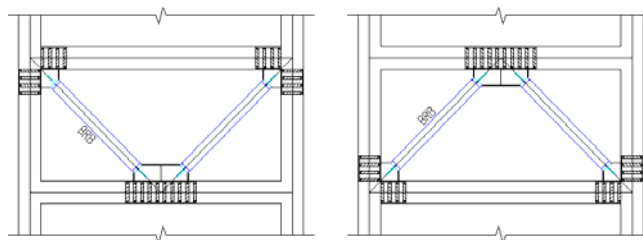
混凝土构件与屈曲约束支撑连接示意
